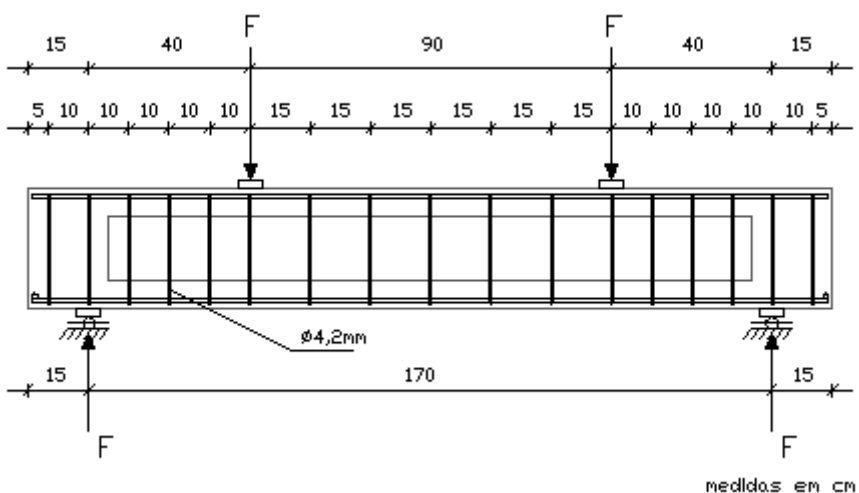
Posição dos estribos, cargas e apoios da viga I-143 B (LEITE JÚNIOR, 2000)
